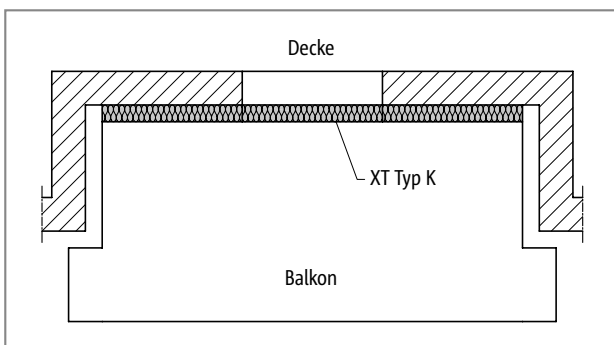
Schöck Isokorb® XT Typ K: Balkon bei Fassadenrücksprung
